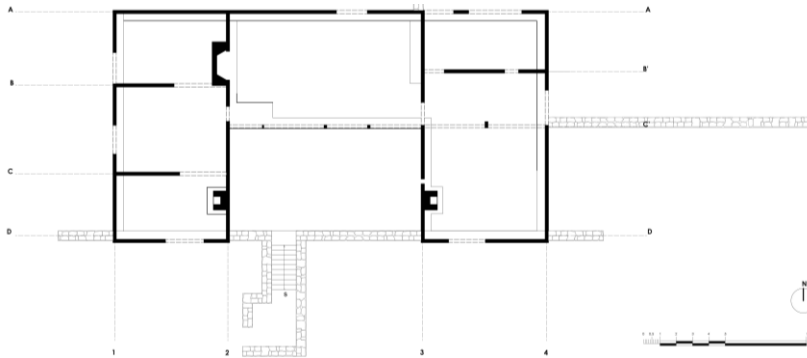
Esquema gráfico de la modulación estructural en planta baja. Fuente: Autor.
